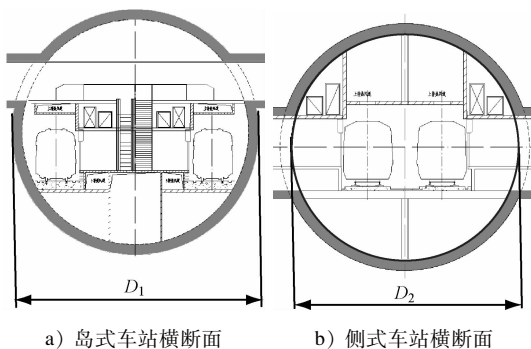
采用大直径盾构全断面施工的地铁车站横断面布置图
